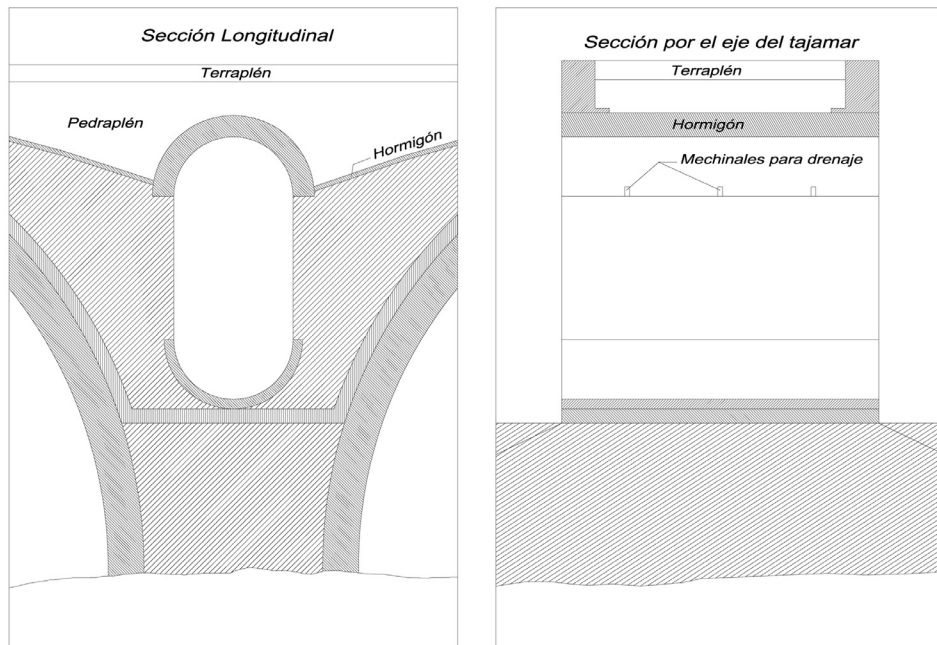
Detalle de la sección longitudinal del puente y sección transversal por el eje de un tajamar.
